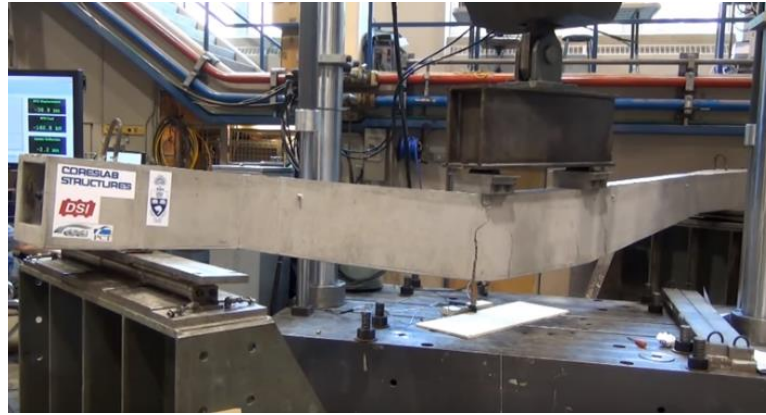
Viga protendida em ensaio de flexão com grandes fissuras de flexão com carregamento próximo à carga última. (Fonte: www.youtube.com/watch?v=6ycbDCnoO8M)
